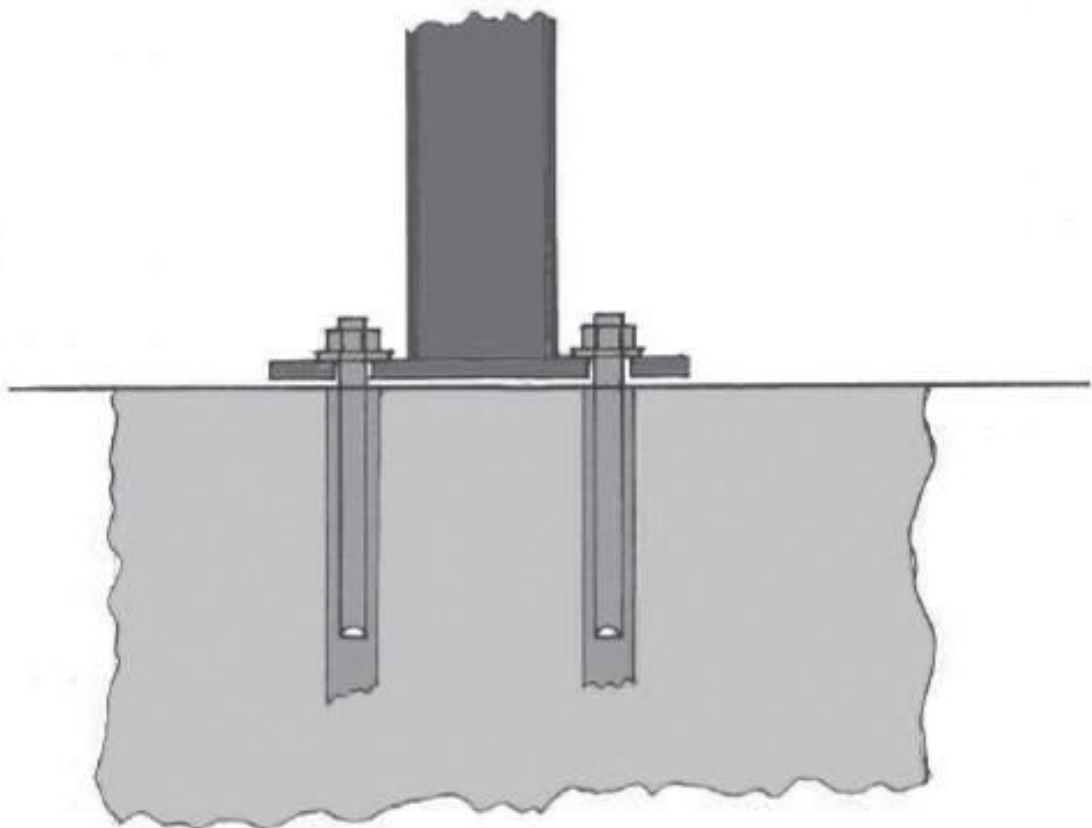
Aplikace „T“ sloupku v konstrukci zahrazovacího sloupku
